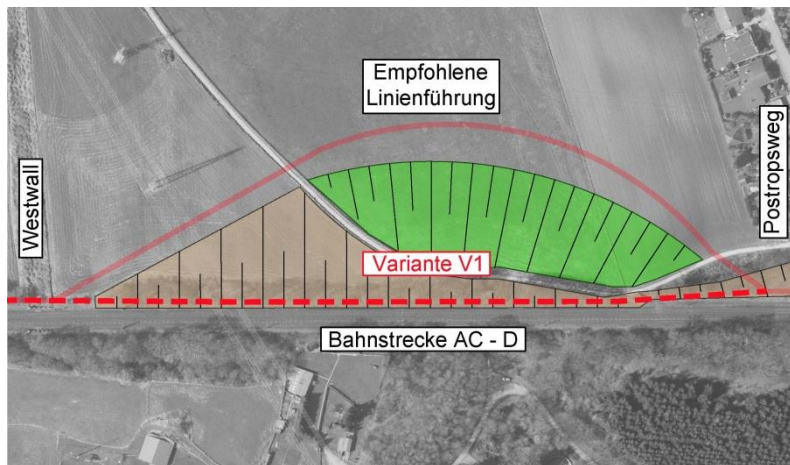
Bahnstrecke im Bereich des Westwalls (Geländeverlauf)
